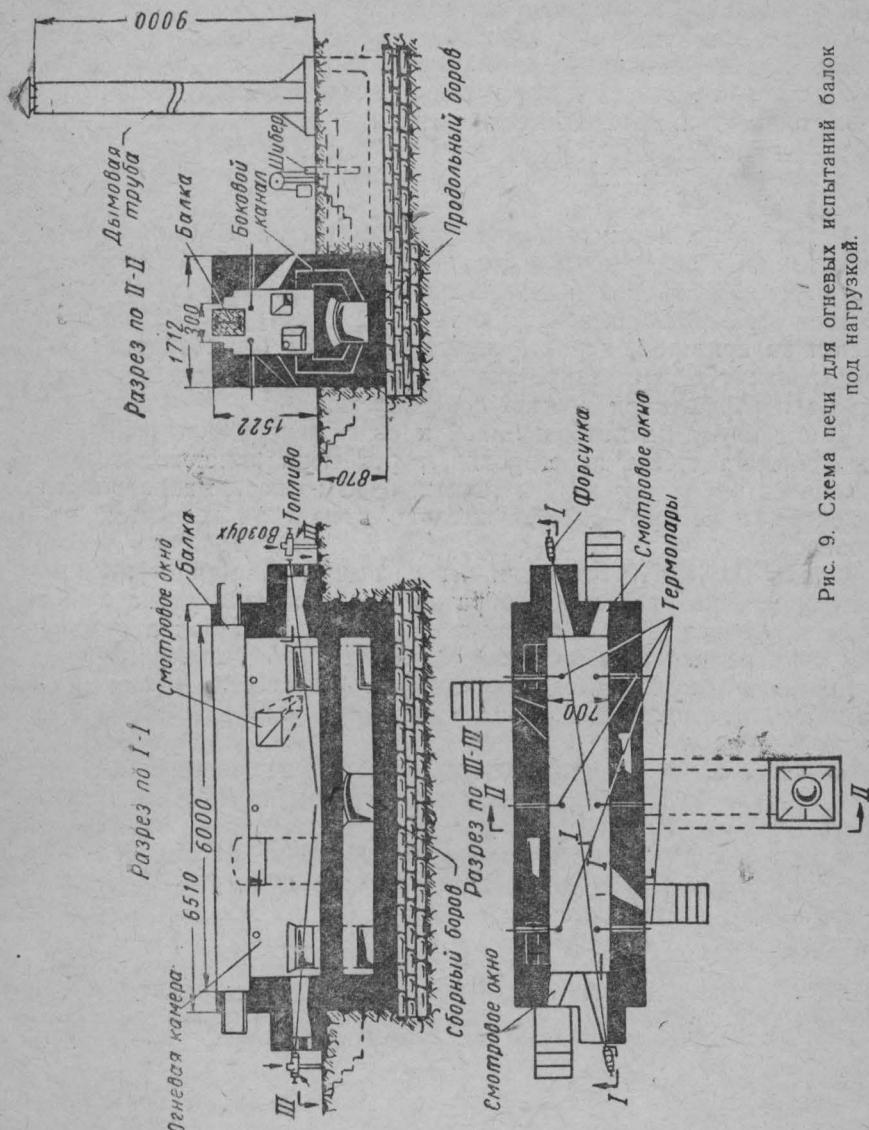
Схема печи для огневых испытаний балок под нагрузкой.
